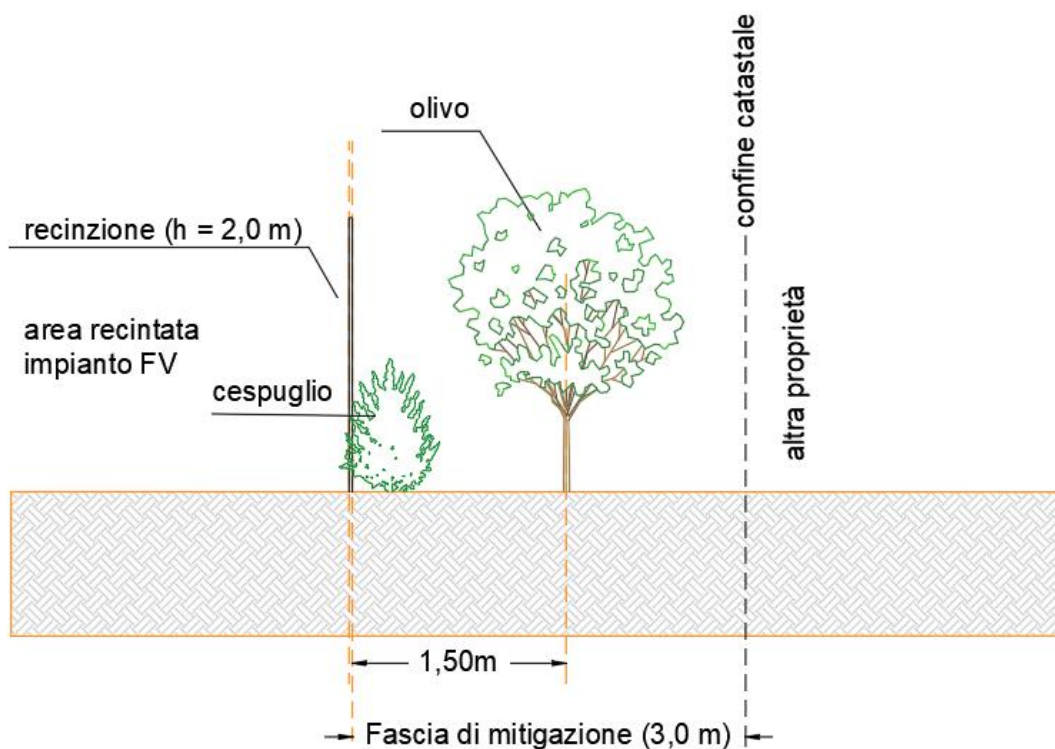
Stralcio di sezione dell'area perimetrale dell'impianto – siepe e filare di olivo.
